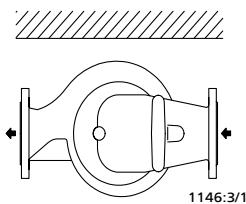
Montaje horizontal (p. ej., debajo de la tapa)
